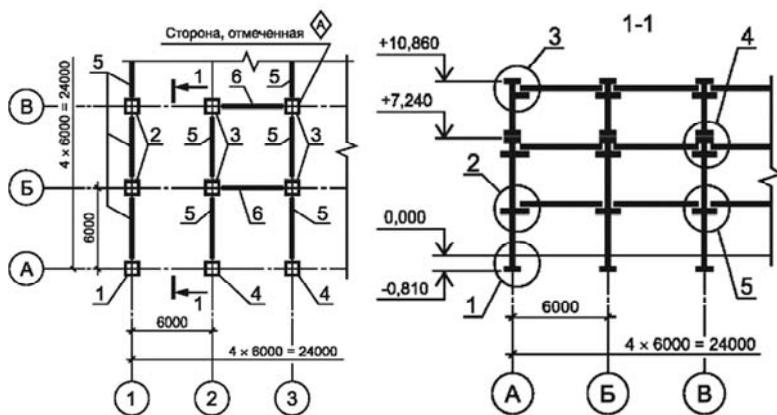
Схема расположения колонн, ригелей и балок перекрытия
